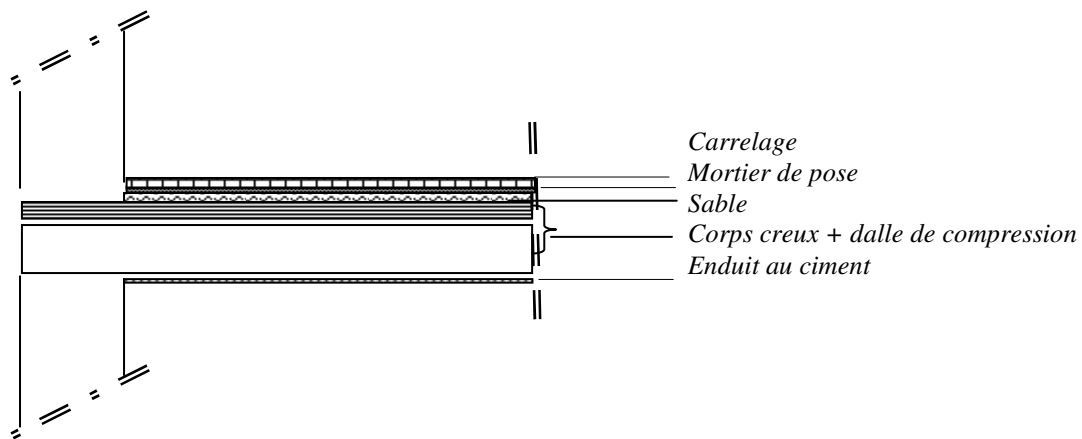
b.: Coupe transversale d'un plancher étage courant
